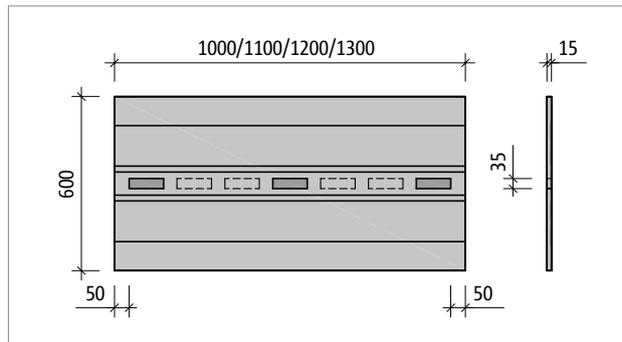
Schöck Tronsole® Typ B-V1...-B600: Produktgrundriss
